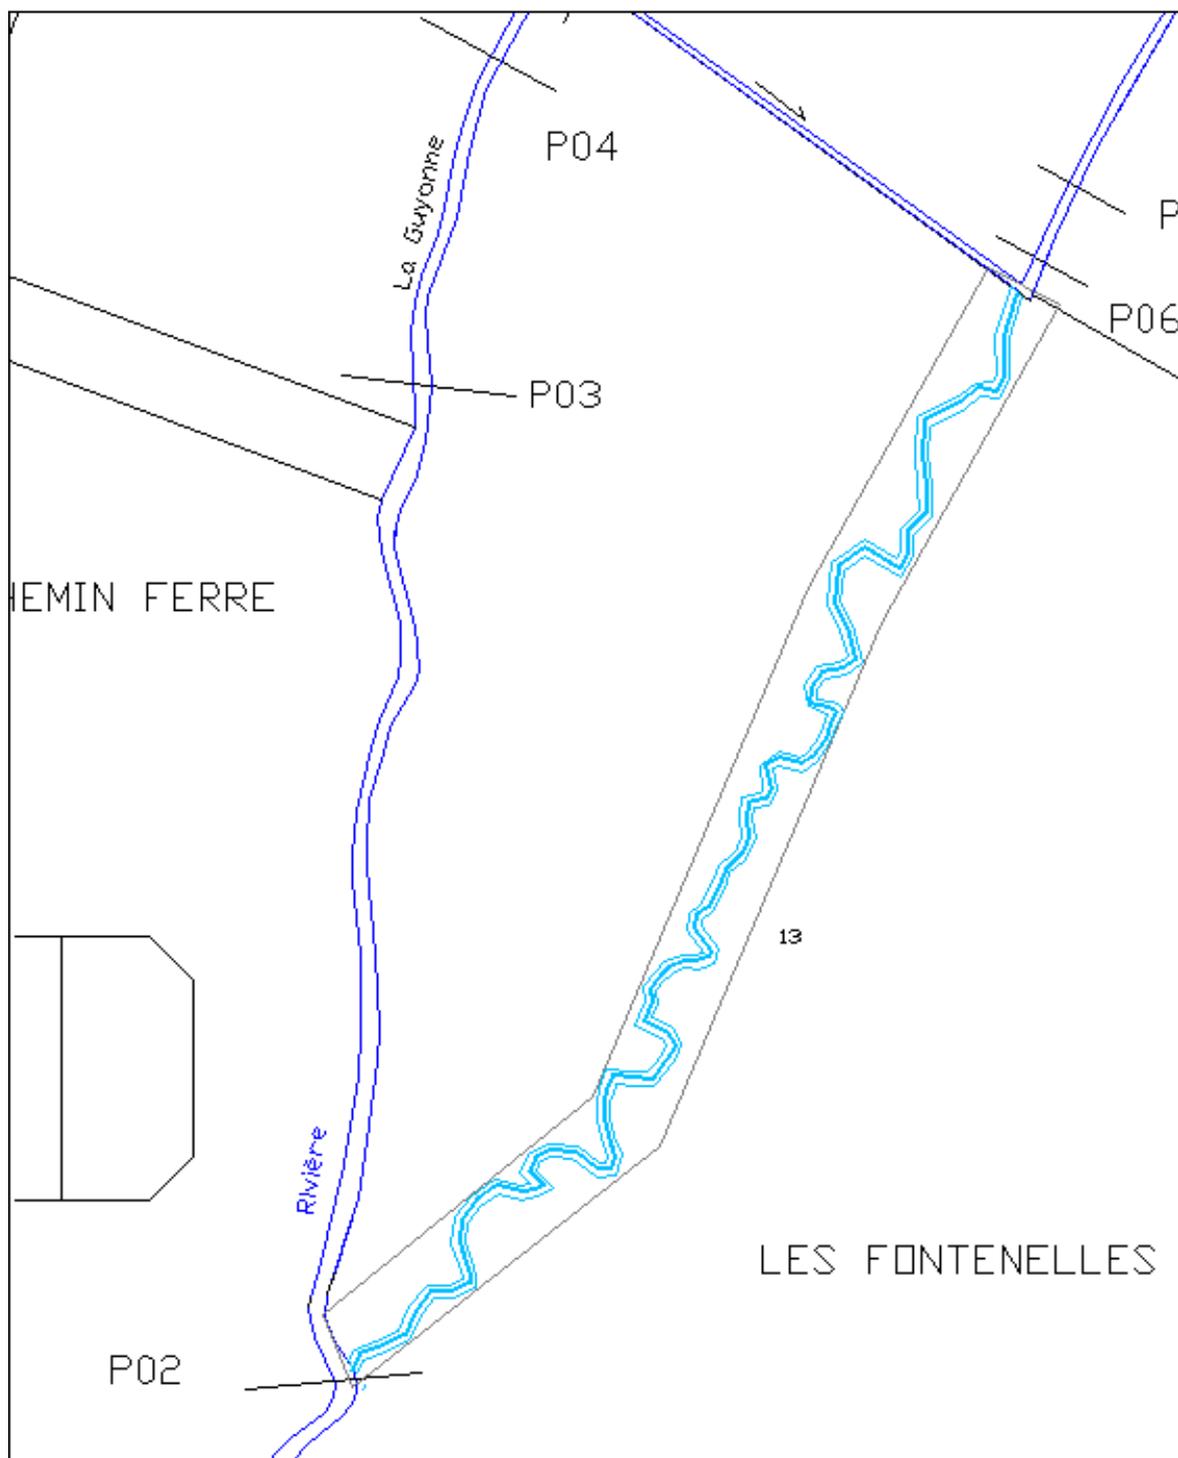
Plan détaillé du tracé en plan du futur lit de la Guyonne dans la zone d'emprise.
